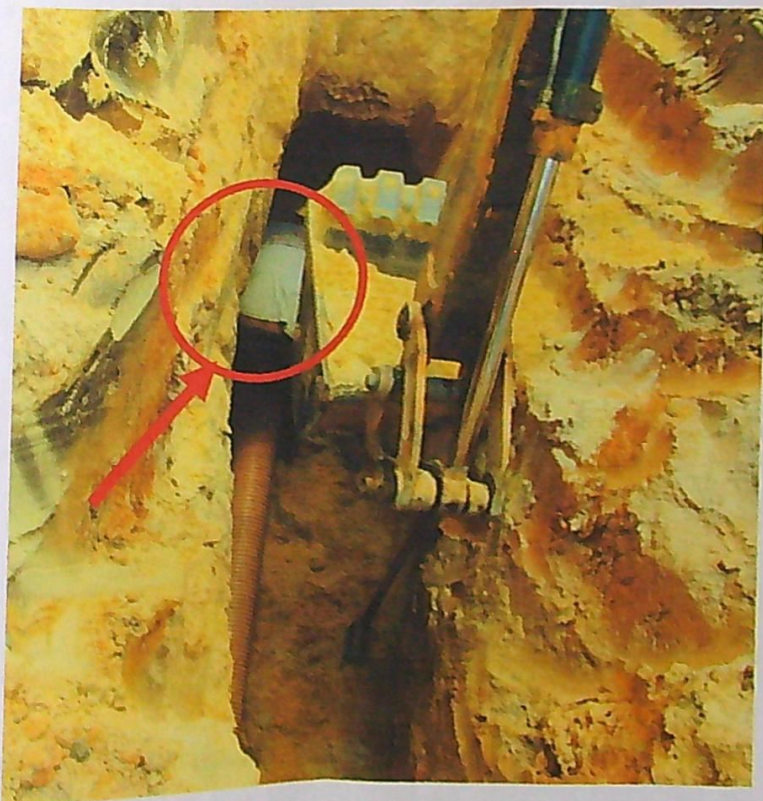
Mal apuntalamiento y/o entibado no protege la excavación.
